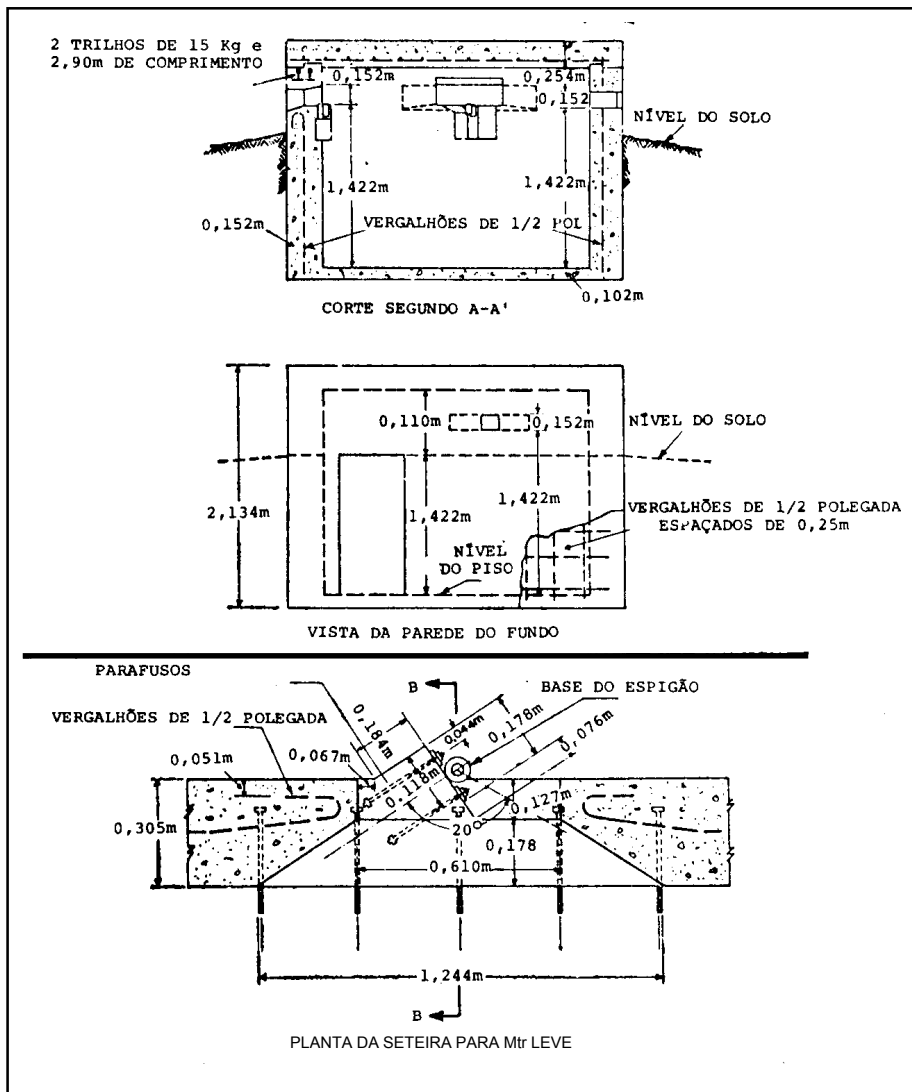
Planta de casamata quadrada, de concreto armado, para metralhadora
